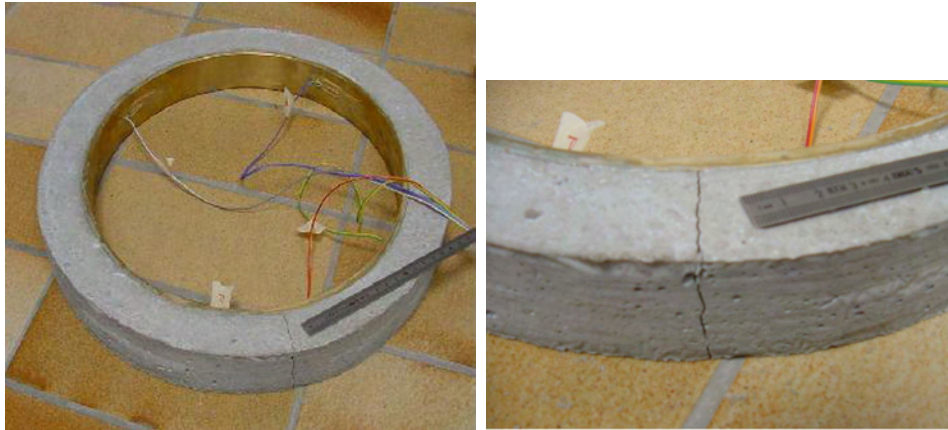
Vues d'un essai d'anneau passif de retrait après fissuration du au retrait
